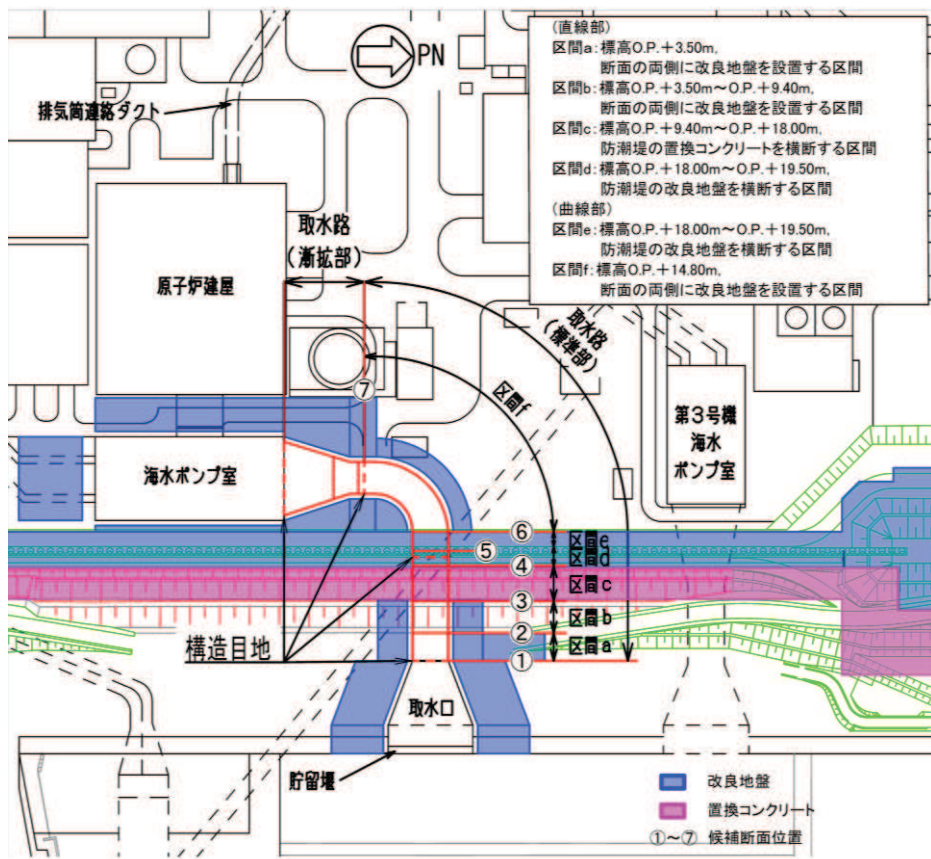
取水路平面図 (区間及び地震時荷重断面位置)
